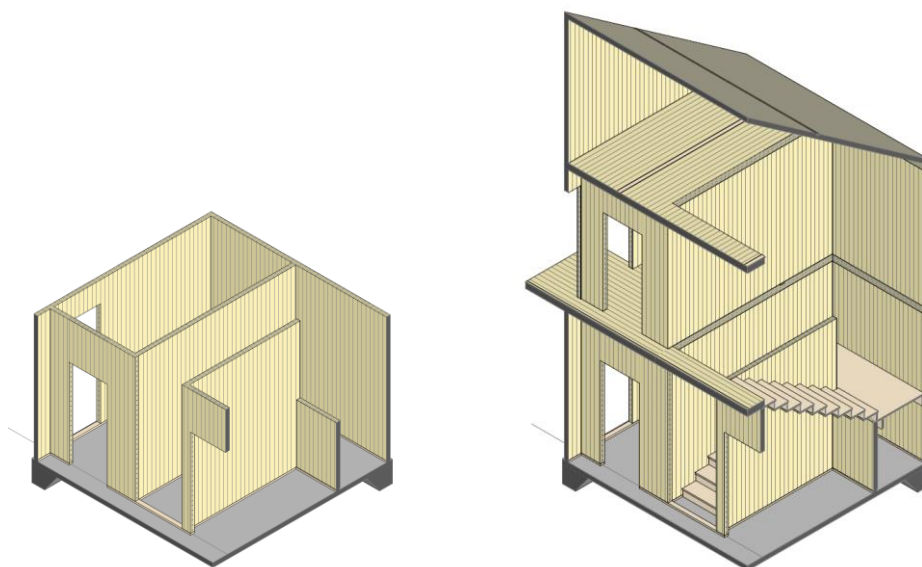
Tipo estrutural com os painéis de parede instalados sobre uma laje de betão aos quais se sucedem os restantes painéis de pavimento e cobertura.
